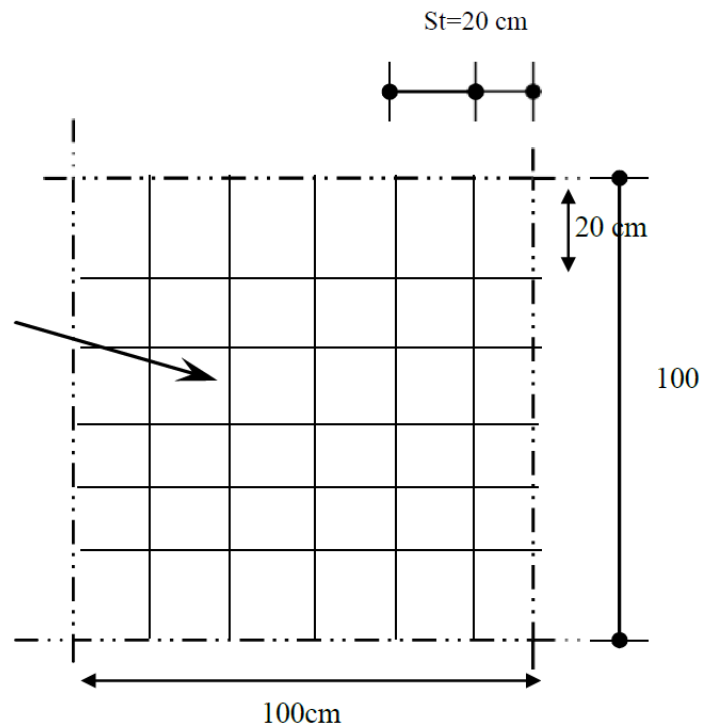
Disposition constructive des armatures de la dalle de compression.
